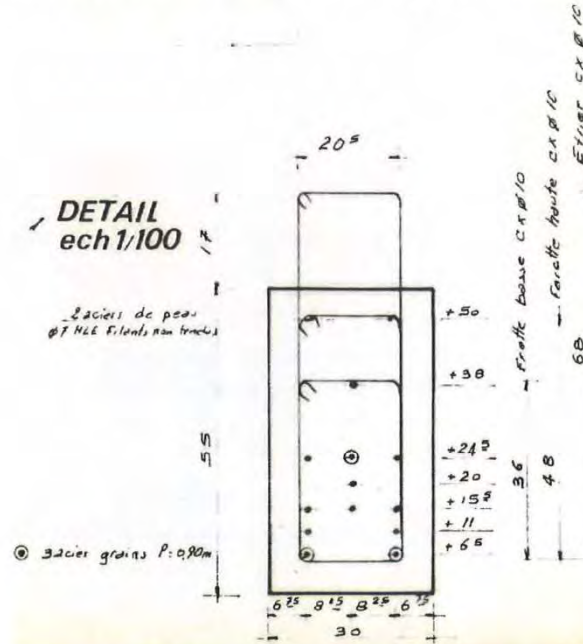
Ferrailage des poutres (Extrait des plan d'archives)
